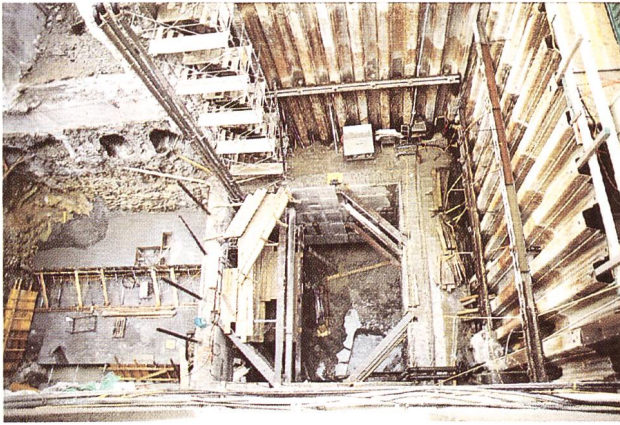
Die Pumpenschacht-Baustelle kurz vor dem Wassereinbruch.
